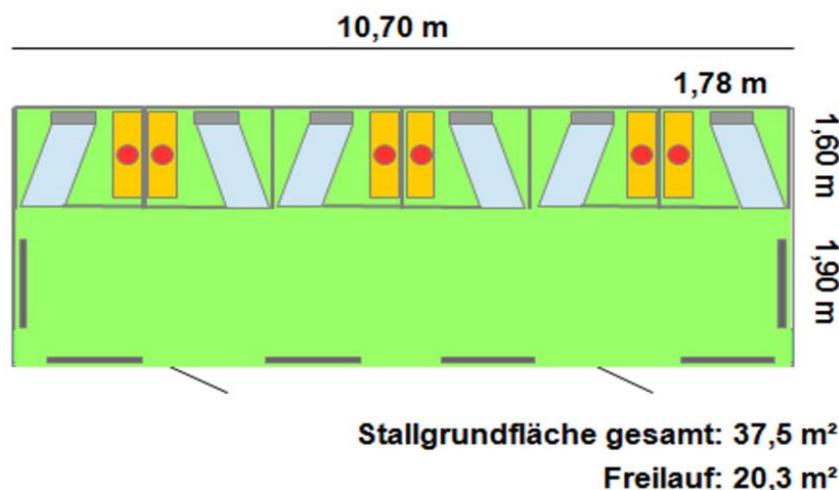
Abteilgrundriss nach Umsetzung einer Gruppenhaltung ferkelführender Sauen im Betrieb D
